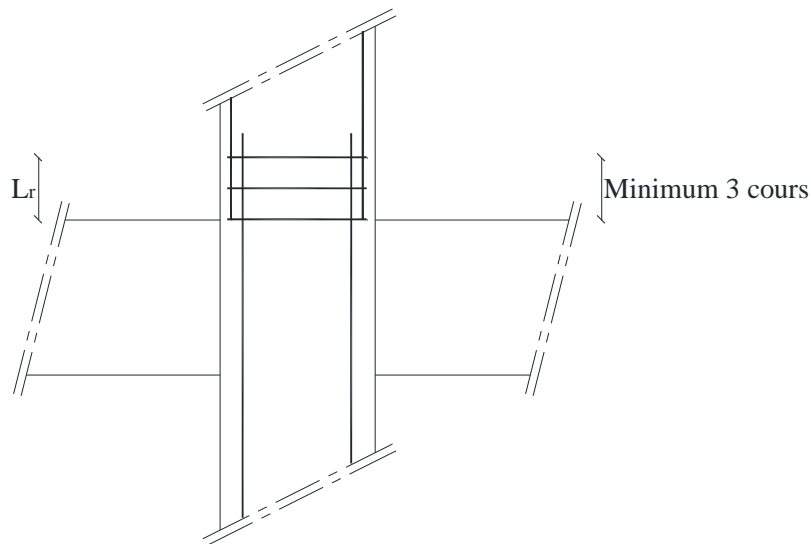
Armatures transversales dans la zone de recouvrement
